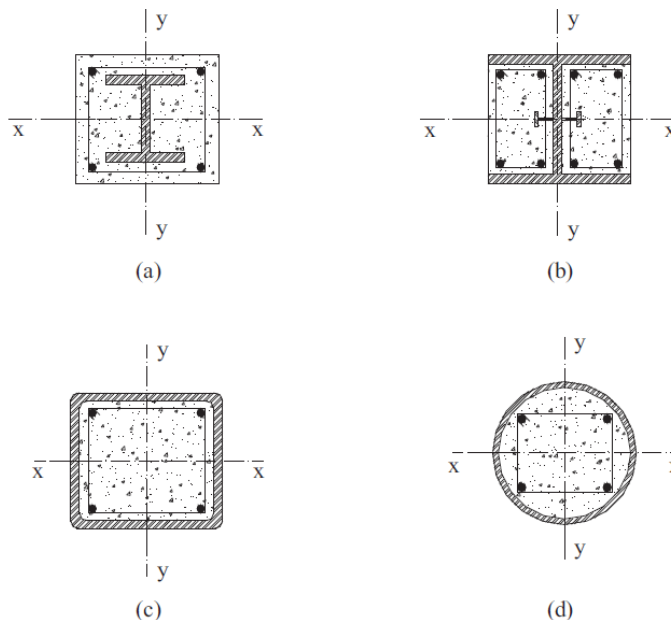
Tipos de seções transversais de pilares mistos
